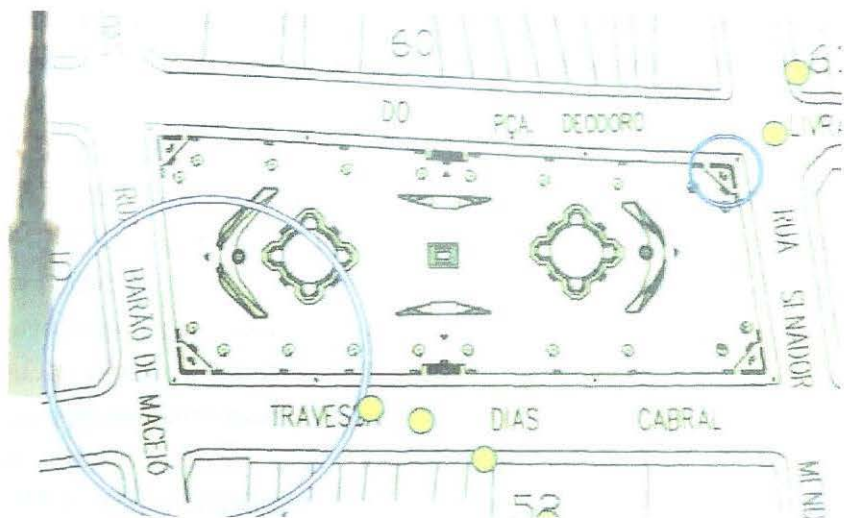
D1 – Planta da intervenção de Rosalvo Ribeiro em 1908.
